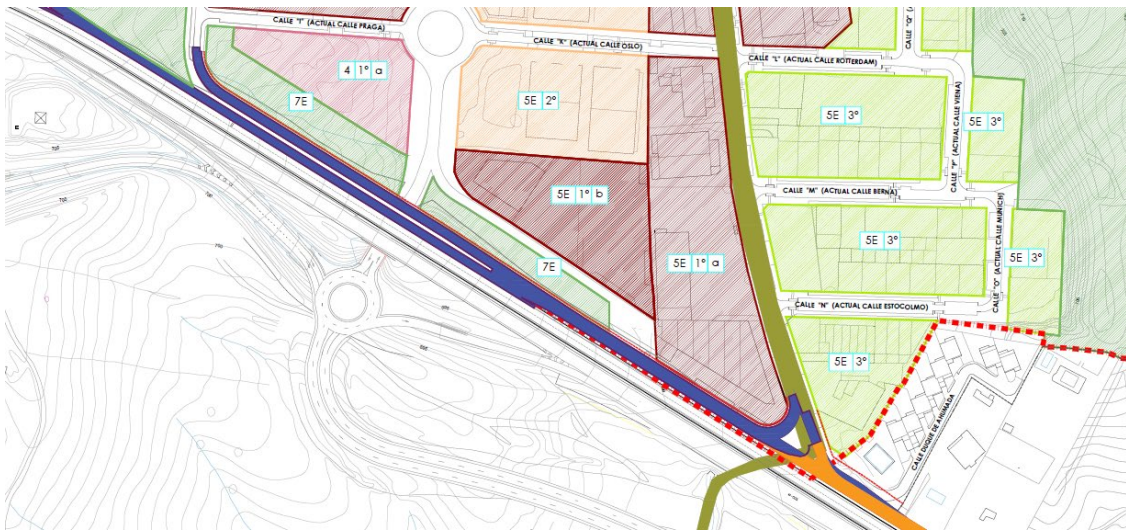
Imagen del plano de ordenación y nueva infraestructura de acceso desde la M 505
